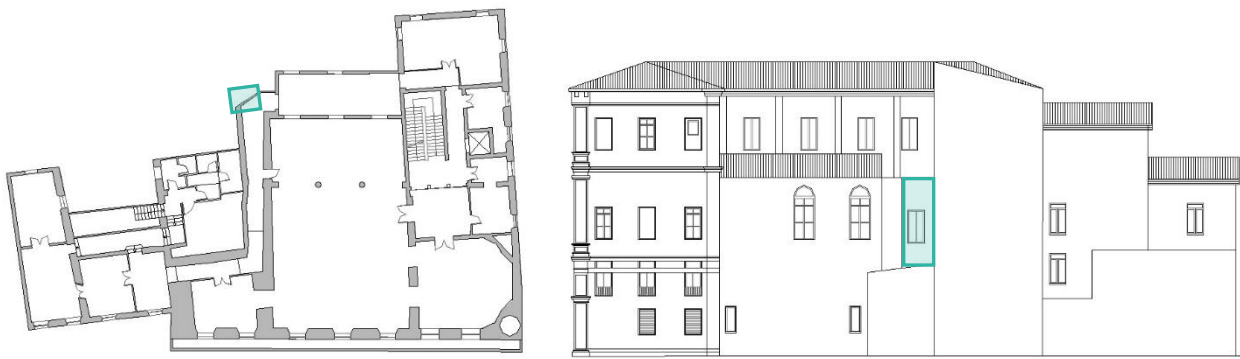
Individuazione macroelemento, pianta e prospetto
